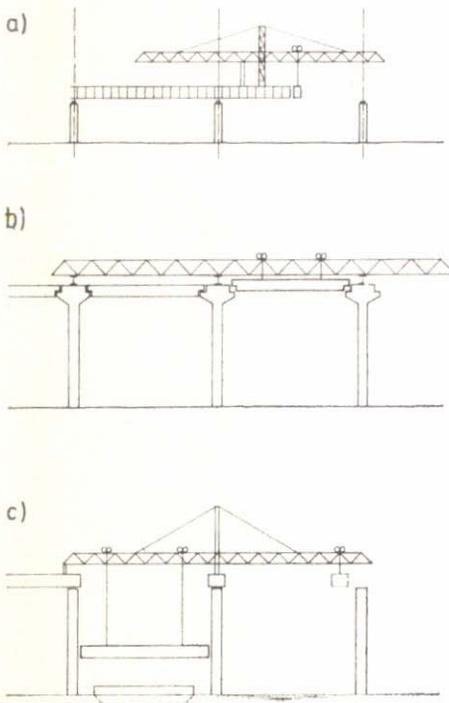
Equipos de montaje para elementos prefabricados.
